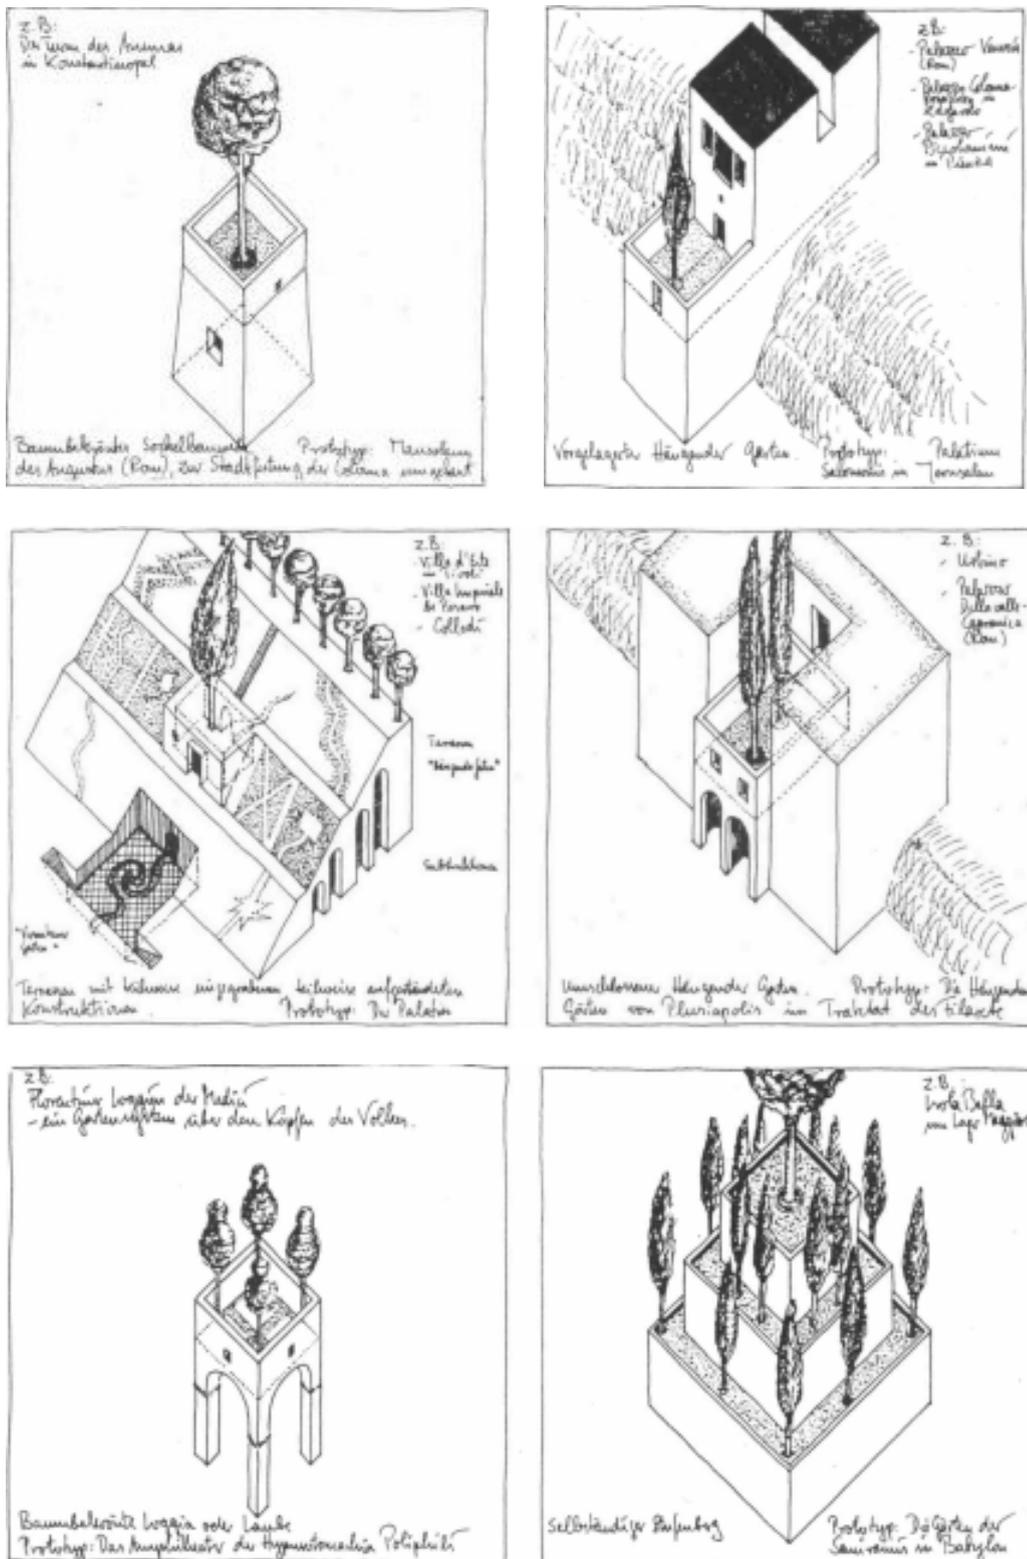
Typologische Übersicht der Grundformen hängender Gärten aus Renaissance und Barock: 1 baumbekröntes Sockelbauwerk, 2 vorgelagerter Garten auf Substruktionen, 3 Terrassen mit eingegrabenen und aufgeständerten Konstruktionen, 4 baumbeständiger Innenhof auf Substruktionen, 5 baumbekrönte Loggia oder Laube, 6 selbständiger Stufenberg. Zeichnungen von J. Pieper (Pieper 1997, S. 158)
